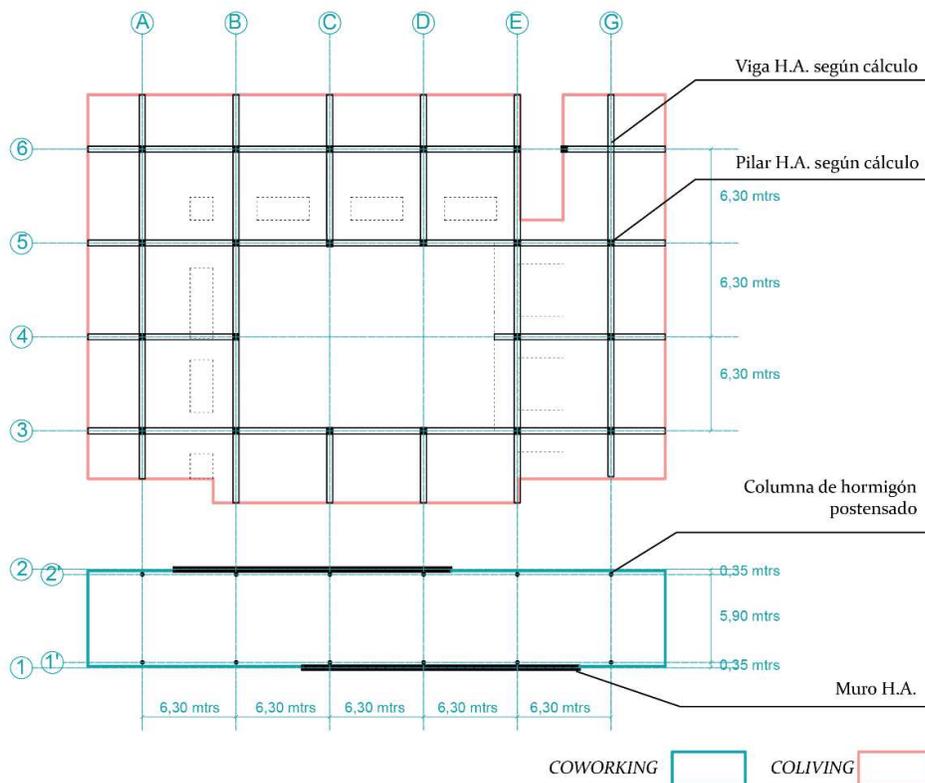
PROPUESTA ESTRUCTURAL EN PLANTA ESQUEMÁTICA. ELABORACIÓN PROPIA
